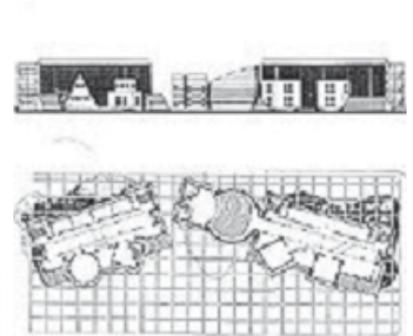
e 40: Foto e Projeto do CPC Colón.
